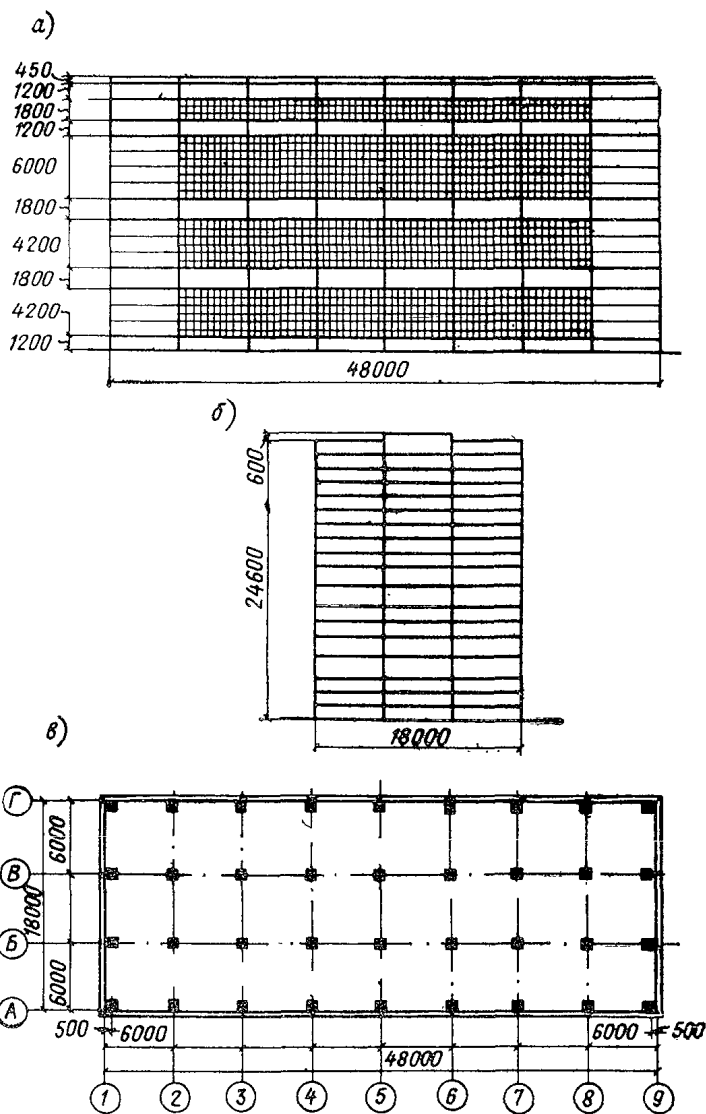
Схемы продольного (а) и торцового (б) фасадов здания и его план (в)
